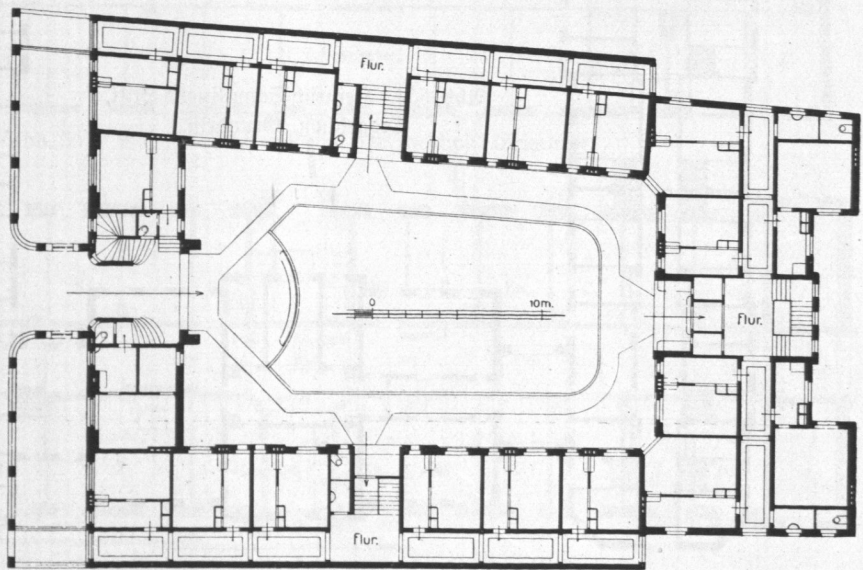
Dirick-Roster-Testaments-Wohnungen, Erdgeschoß, Grundriß.
